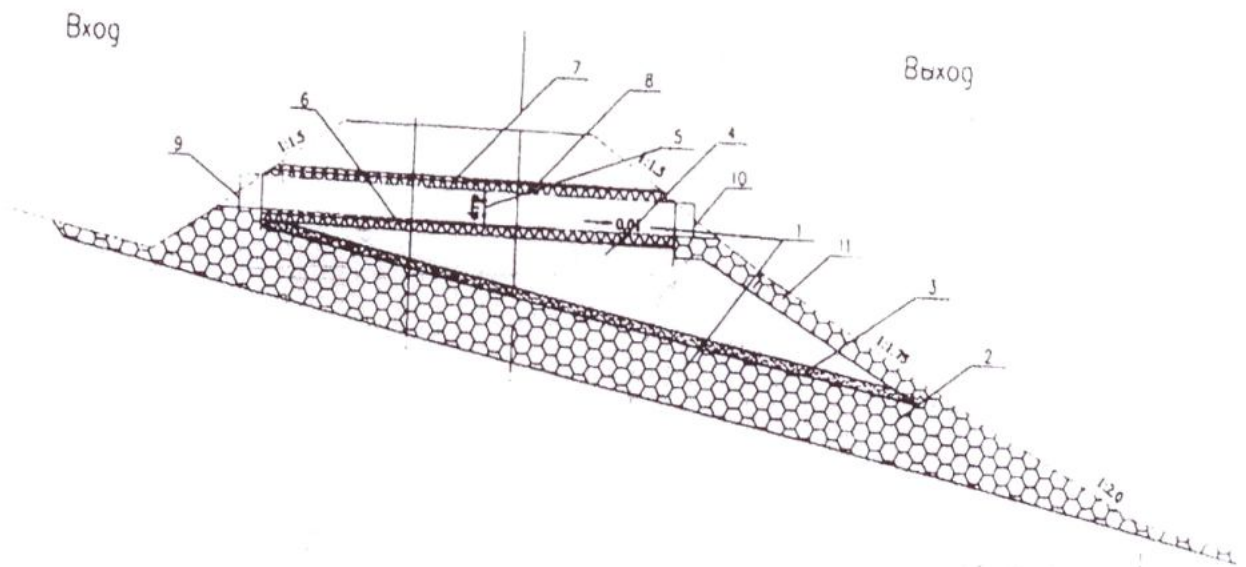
Конструкция водопропускного сооружения, опирающегося на основание укрепленное АНК
